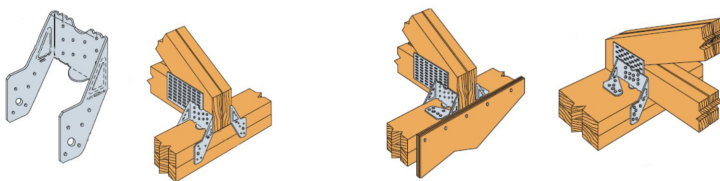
Exemplos de aplicação de cantoneiras reforçadas
